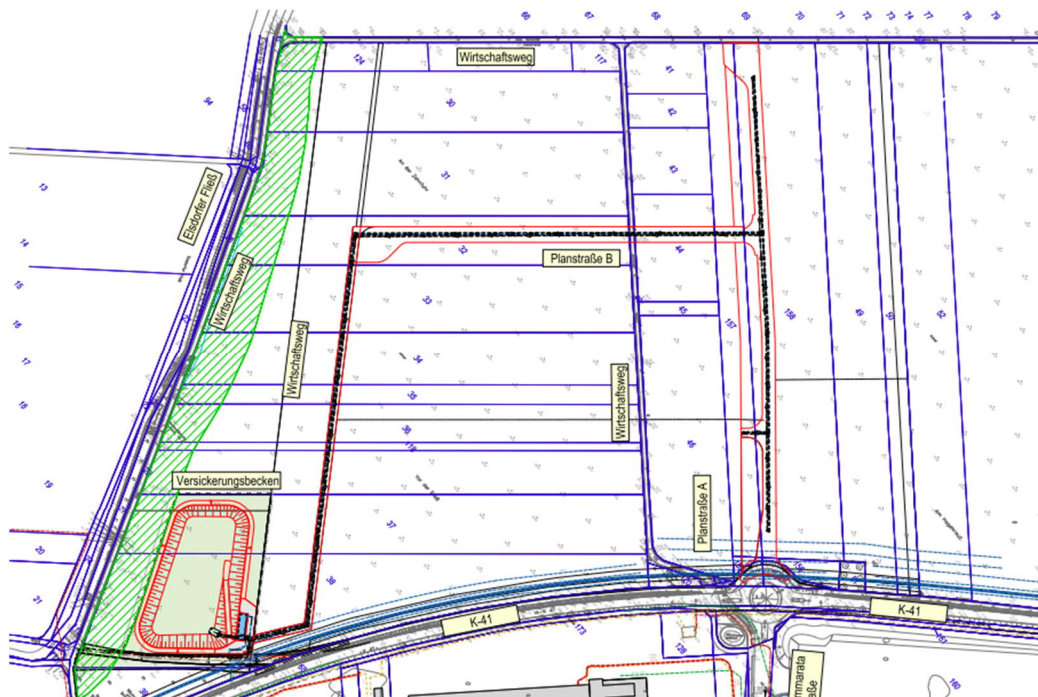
Ausschnitt aus dem Übersichtslageplan, Landschaftsschutzzone LSG 5005-002 in grün markiert.
